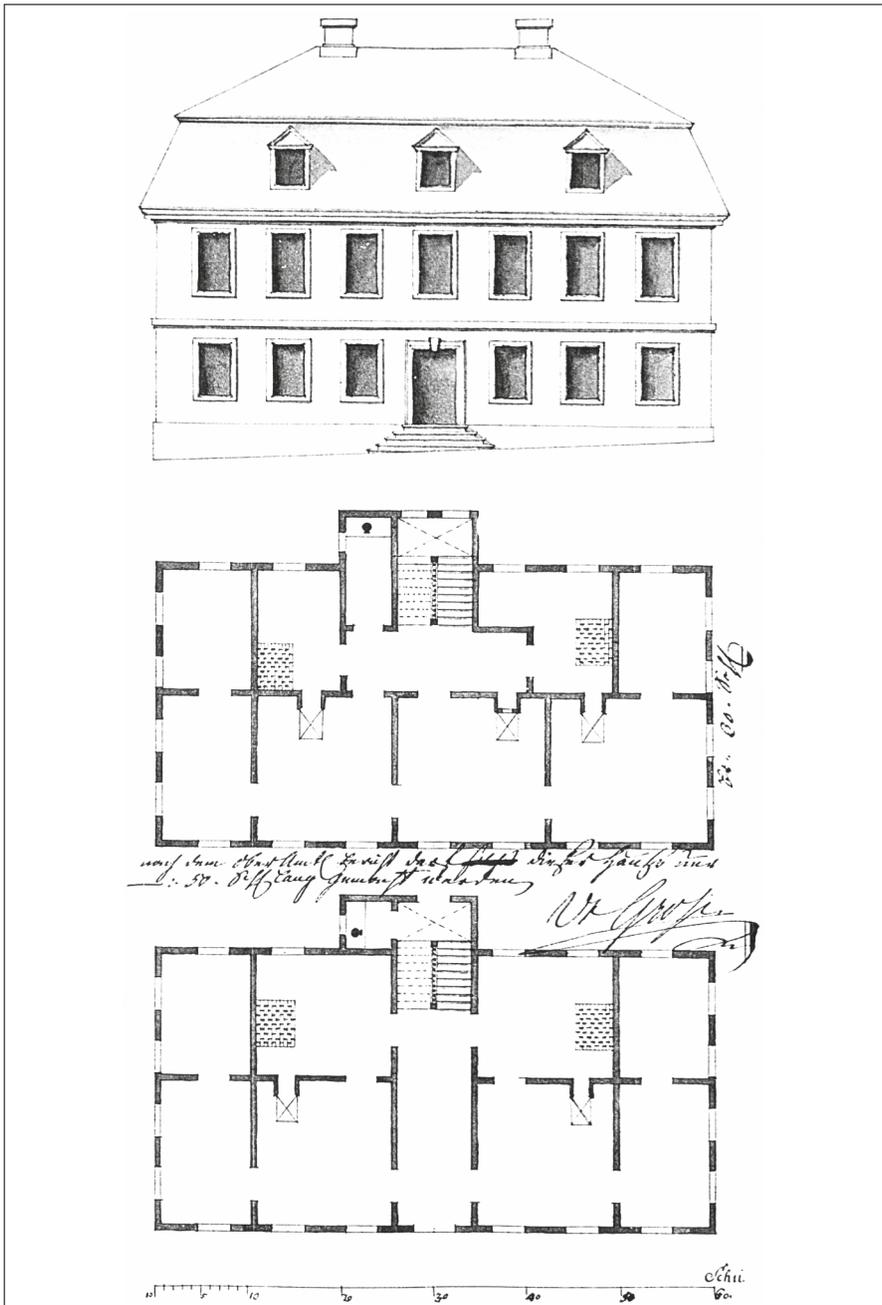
Plan Nr. 26, typisch für Zeichner »B«, Doppelhaus mit gemeinsamem Eingang, U-förmige Treppe mit Zwischenpodest, gebrochenes Dach, Wohnung mit vier Räumen, geplant 1770.
